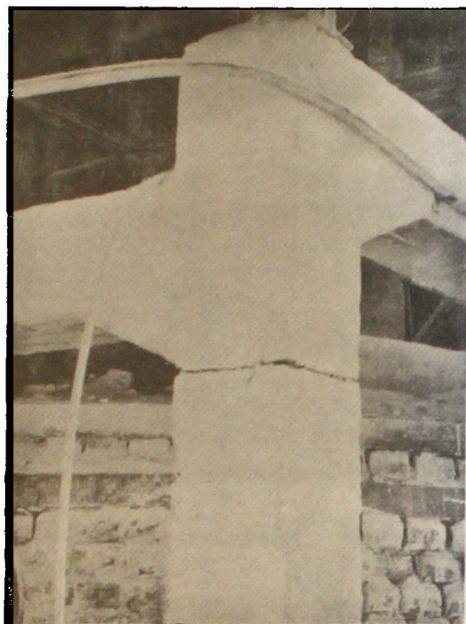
Junta de hormigonado entre pilar y viga. Planta de yeso de El Volcán.
